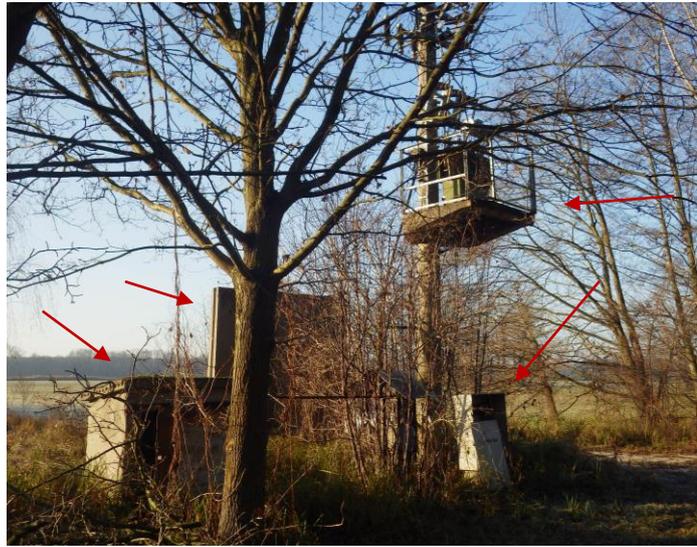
Betonmast-Trafostation mit Bestandteilen
